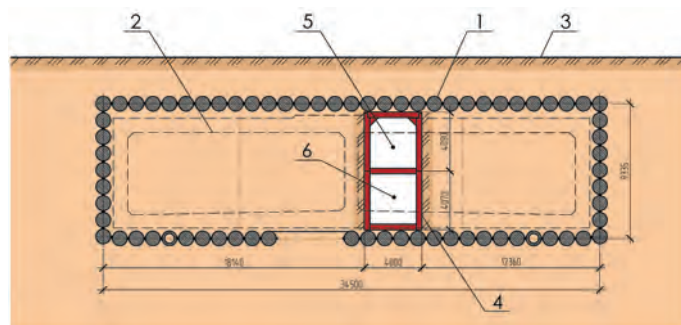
Поперечное сечение участка проходки: 1 – защитный экран из труб; 2 – контур обделки тоннеля; 3 – поверхность земли; 4 – рама крепления продольной штольни; 5 – верхний ярус продольной штольни; 6 – нижний ярус продольной штольни
